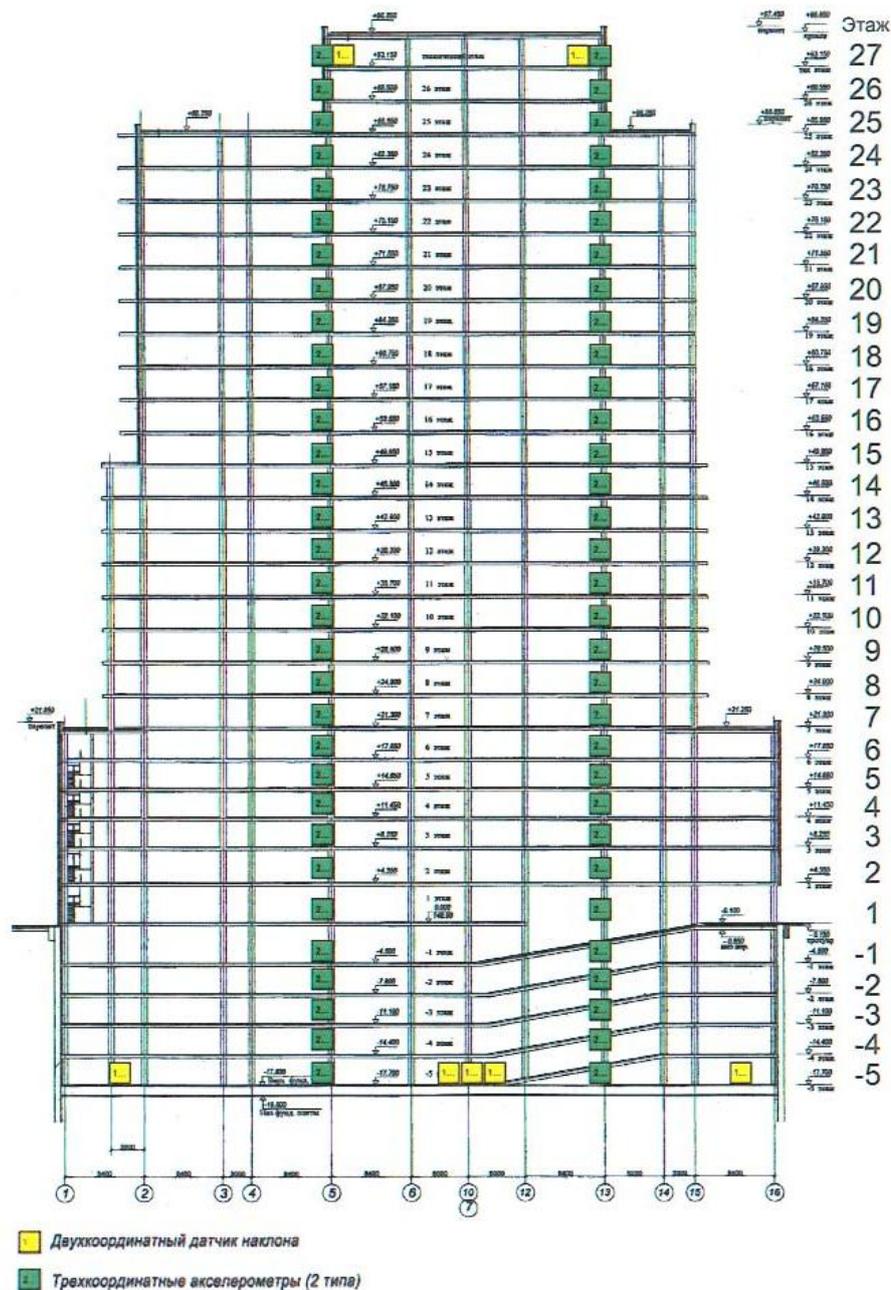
Схема размещения измерительных пунктов на разрезе конструкций высотного здания
